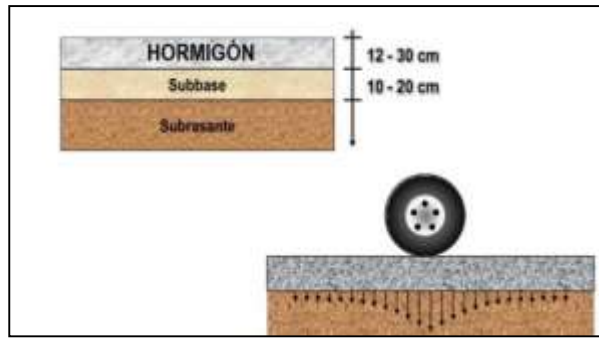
Esquema típico del paquete estructural de un pavimento rígido
